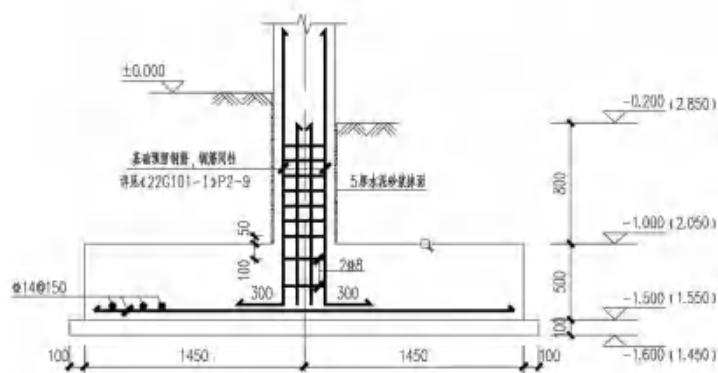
综合仓库、化学品仓库、THF 灌装站、危废品等基础断面图
